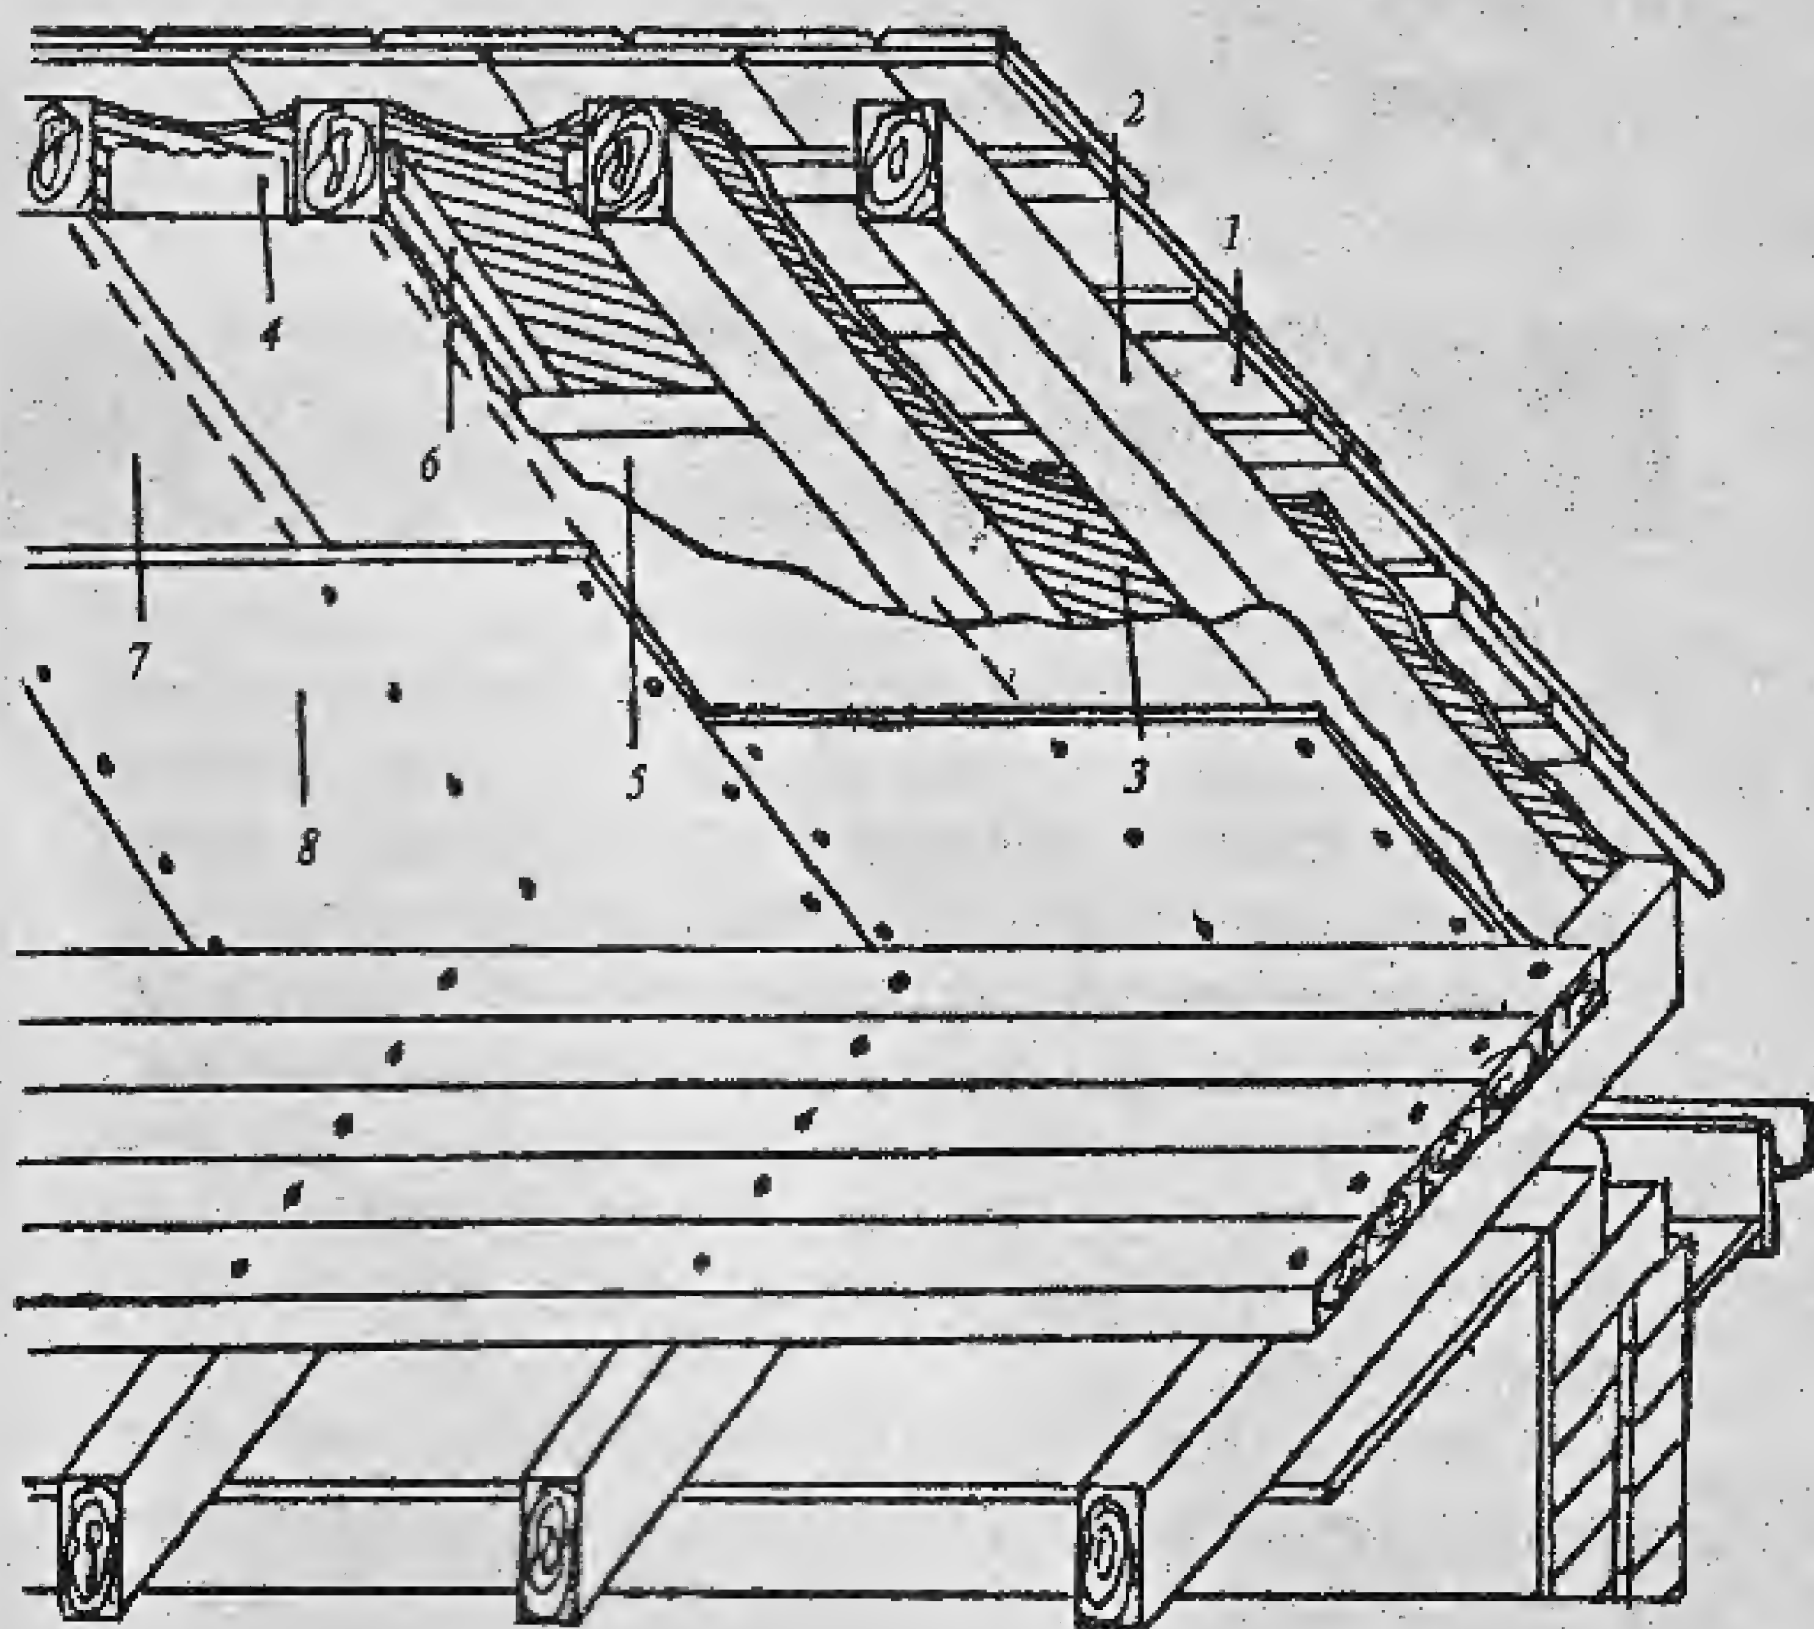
Утеплення схилів даху: 1 – покрівельне покриття; 2 – кроквяна нога; 3 – гідроізоляційний шар; 4, 5 – теплоізоляційні плити; 6 – планка; 7 – декоративна панель.
